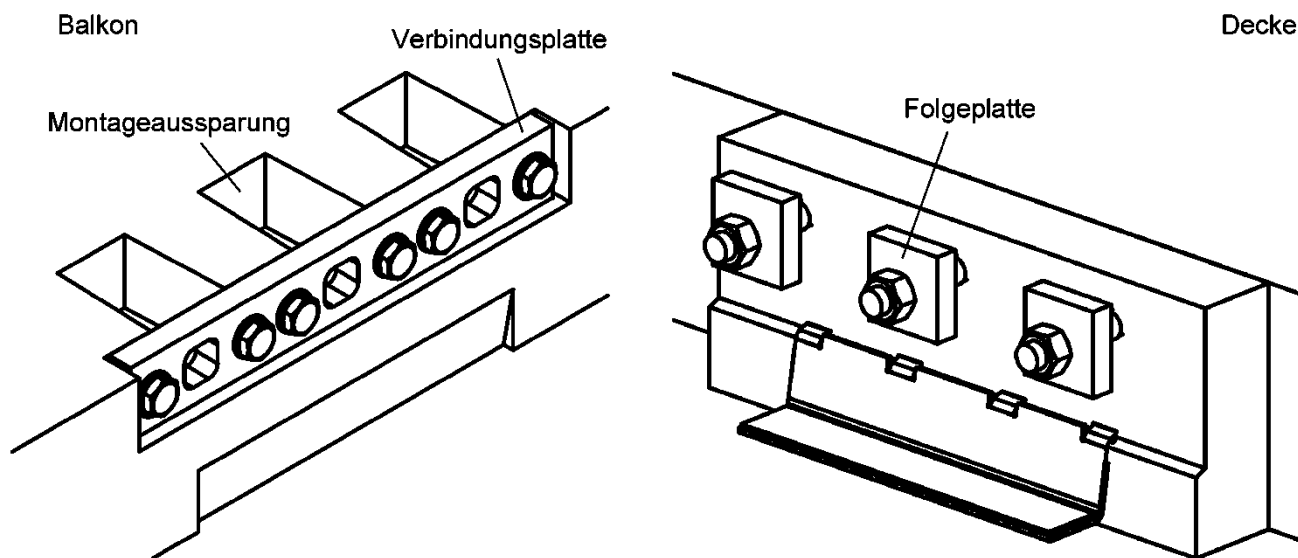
Isokorb® IQ-K-B: Zugstäbe deckenseitig einbetoniert, Schraubverbindung balkonseitig
